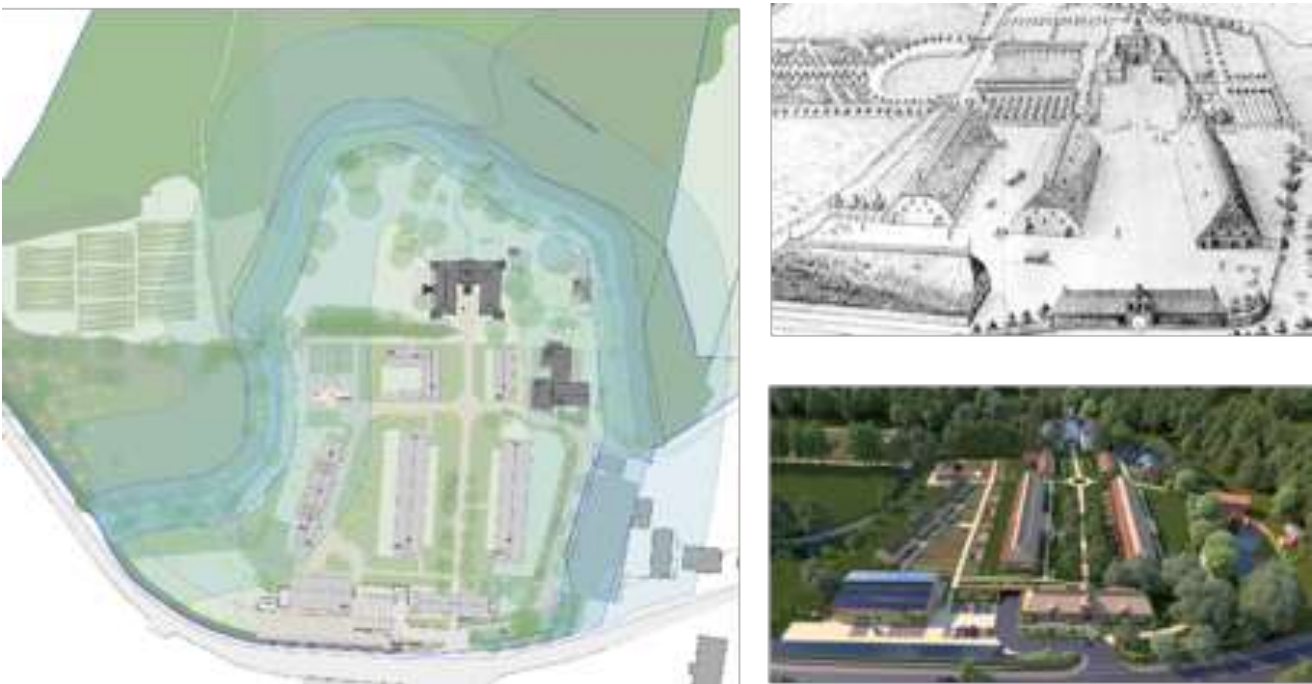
Lageplan Gut Rantzau, historischer Lageplan, Visualisierung Vorhaben Gut Rantzau
